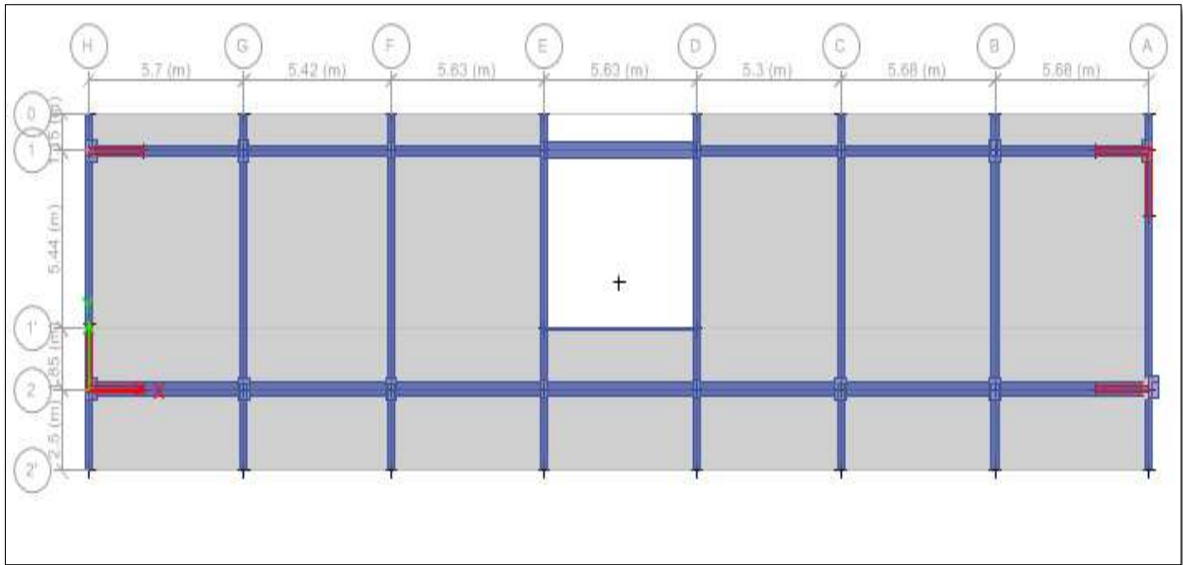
Planta N+2.70 Estructura 1 CENIGRAF
